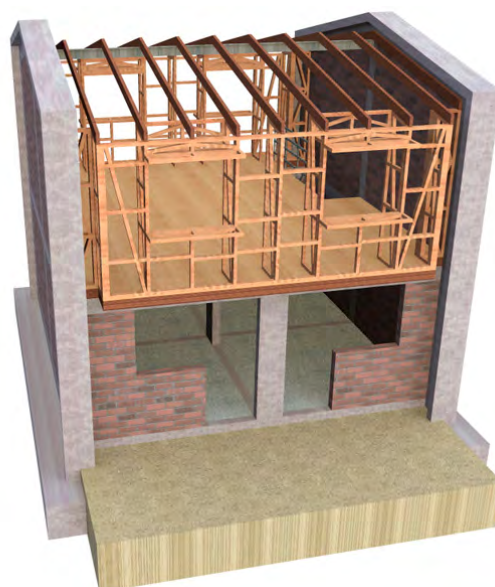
Descanso de la estructura de techumbre en el cerramiento (propuesta)
